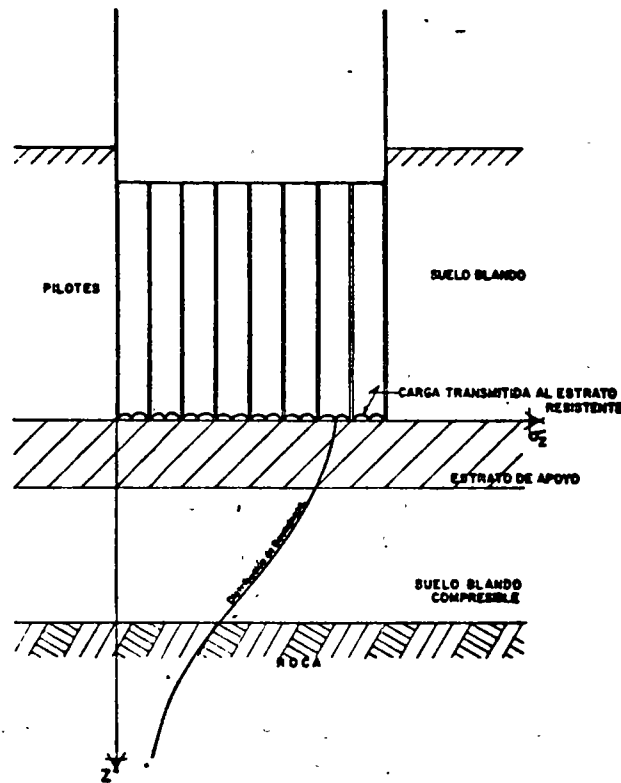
Método para calcular asentamientos bajo pilotes de punta
